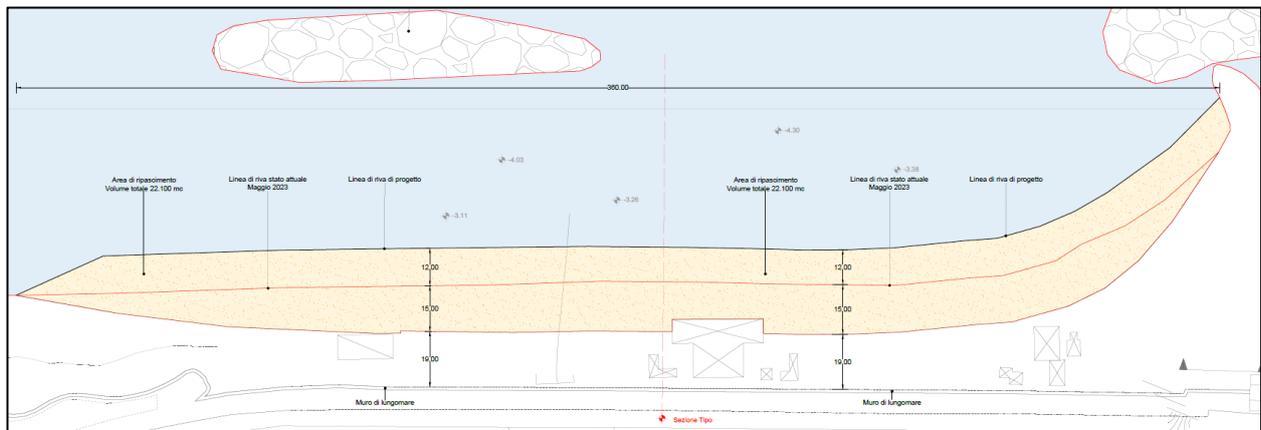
Planimetria di ripascimento del litorale di Roccella Ionica
